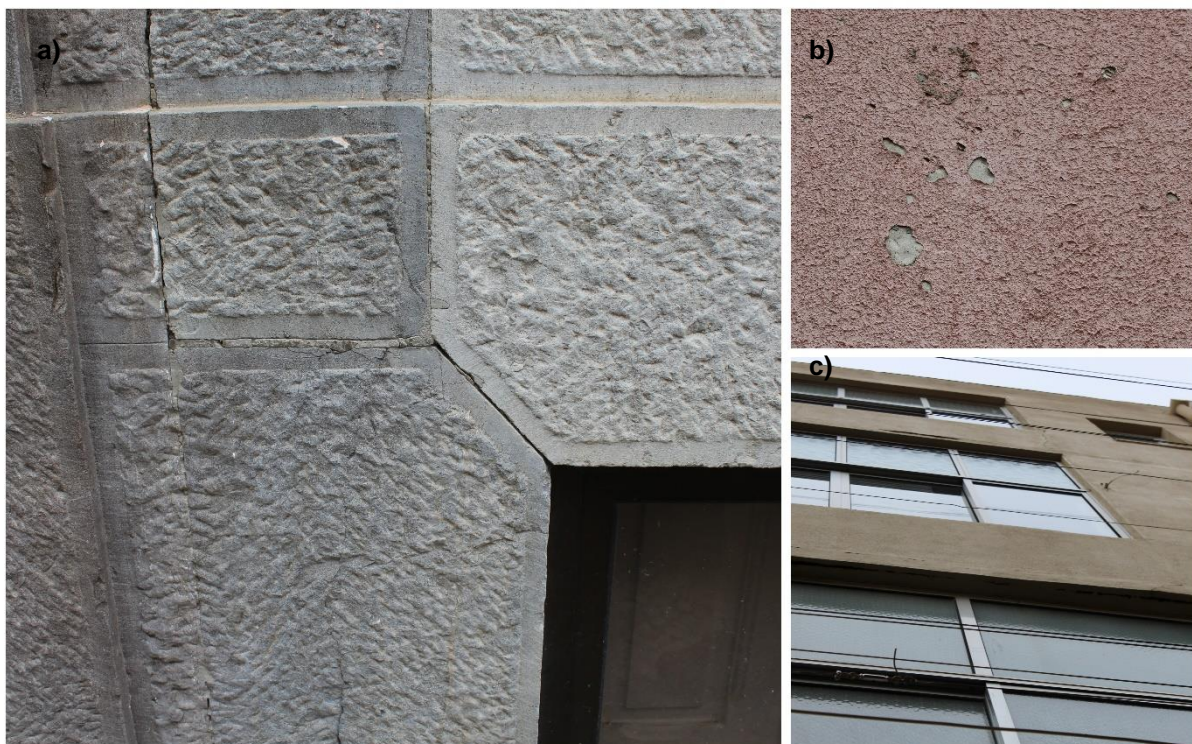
Anomalias no elemento parede exterior (revestimento exterior). a) Falta de preenchimento das juntas (PE 1.2); b) Descolamento da tinta (PE 1.1); c) Fissuração (PE 1.3).
